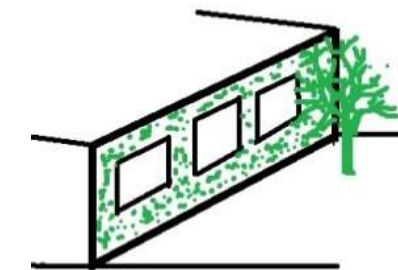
Fachadas verdes, vegetación junto a fachadas. Fuente: García. (2014)
